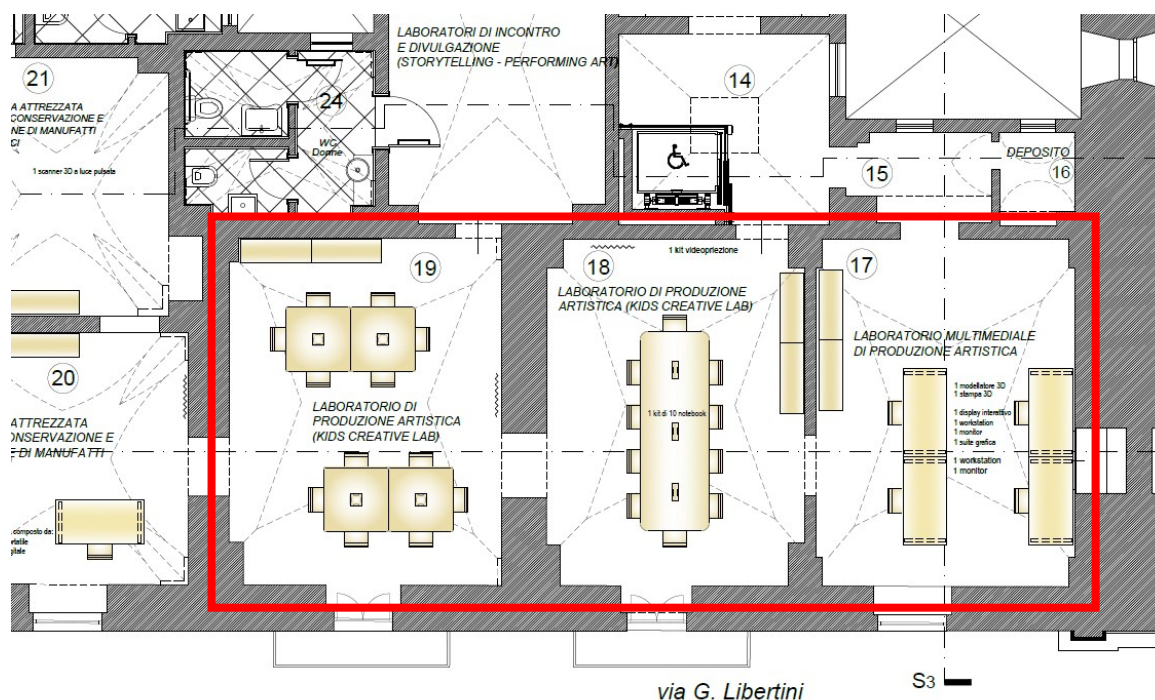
Stralcio della planimetria del piano primo con individuazione delle sale 17, 18 e 19 (in rosso)
